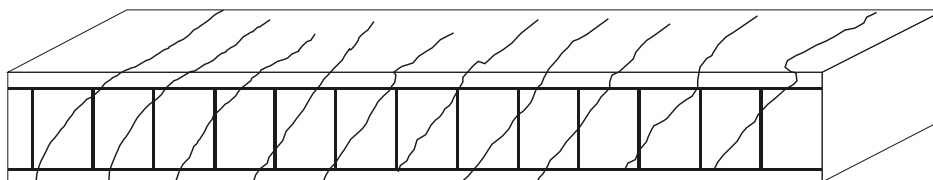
Fissuras de torção em uma viga.
